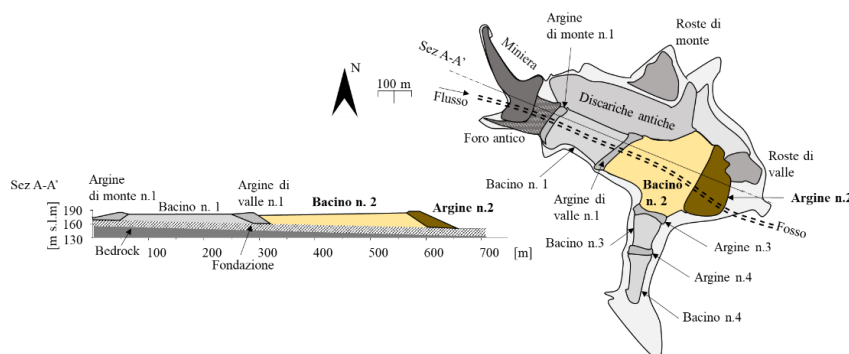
Sezione e planimetria d'insieme con il bacino di decantazione studiato (Bacino n. 2 e Argine n. 2).
